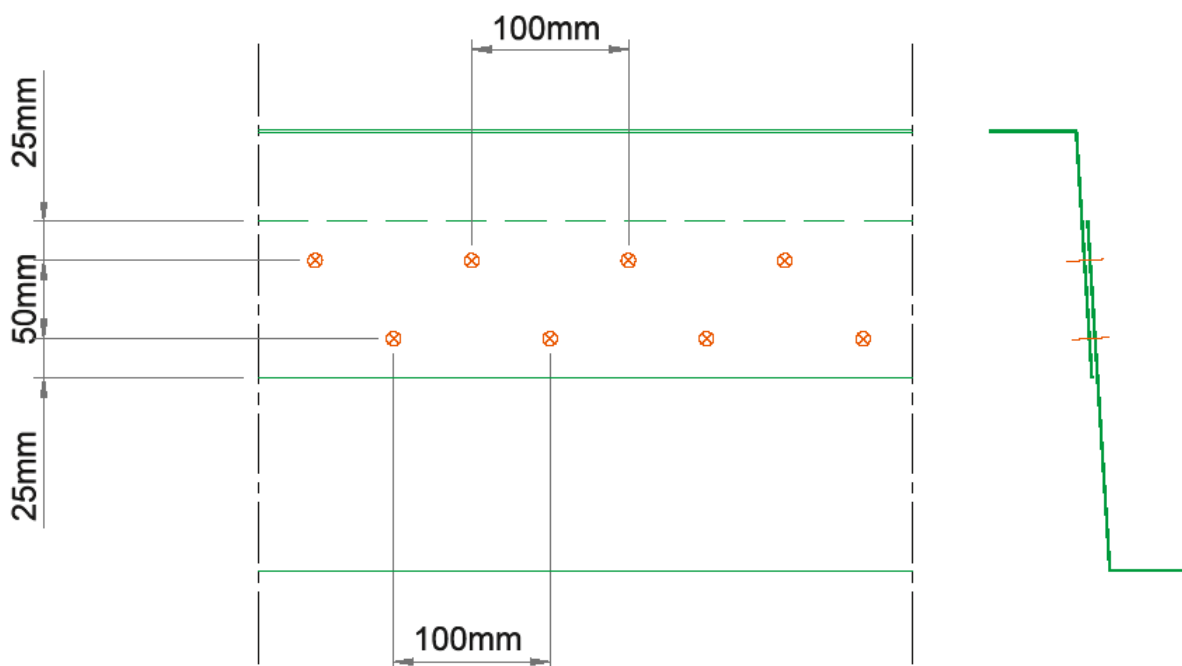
Coupe horizontale du couturage de la bavette de recouplement
